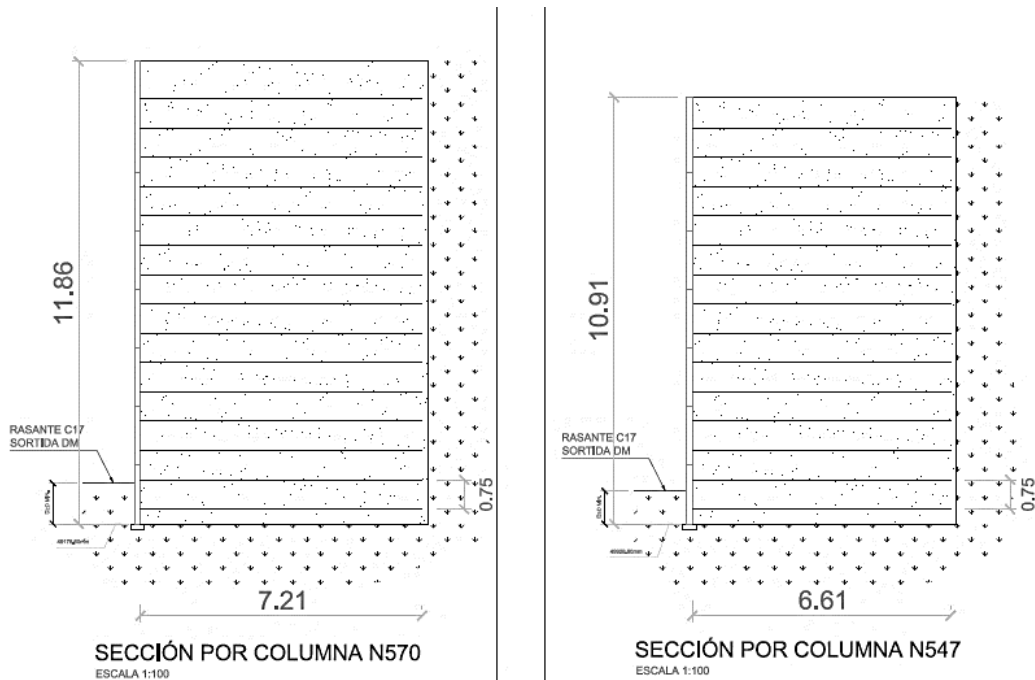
Detalle, sección transversal, longitud y separación vertical para distintas alturas de muro (unidades en metros).
